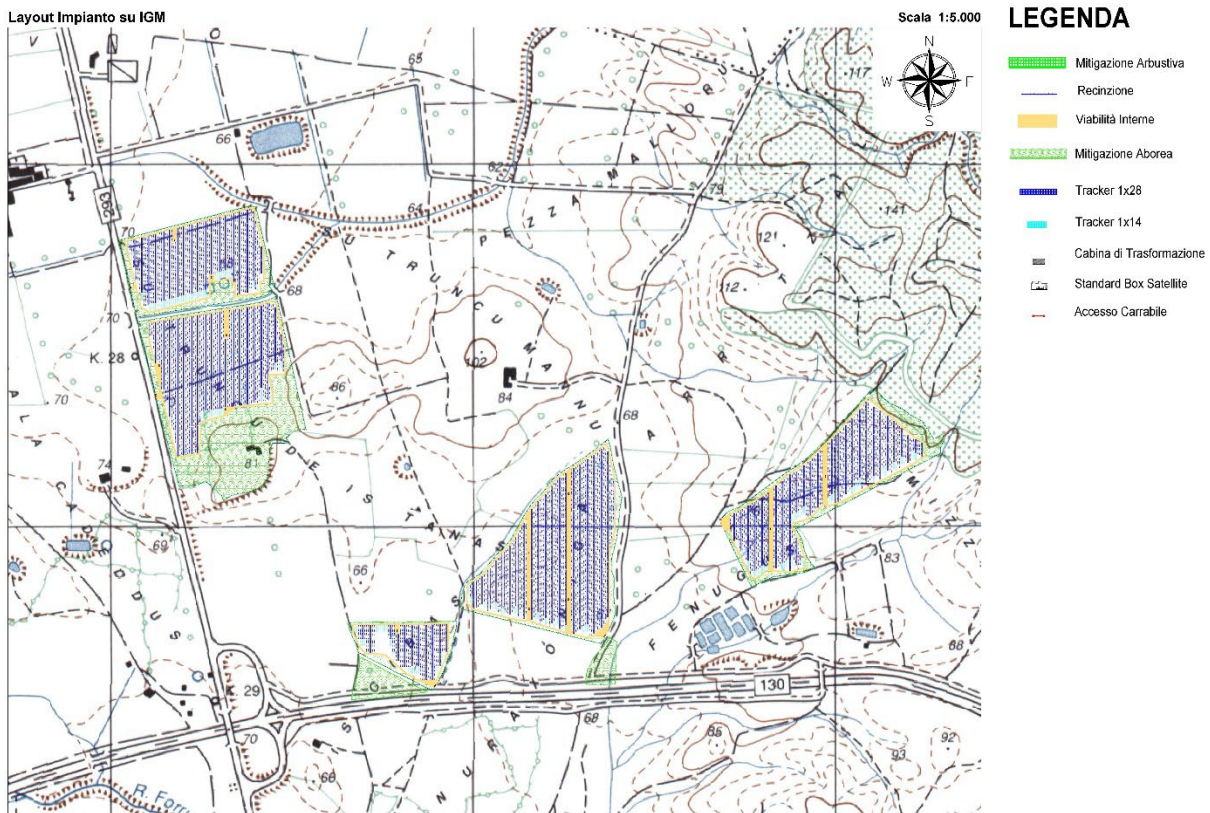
Layout del futuro impianto FV_SILQUA su I.G.M.
